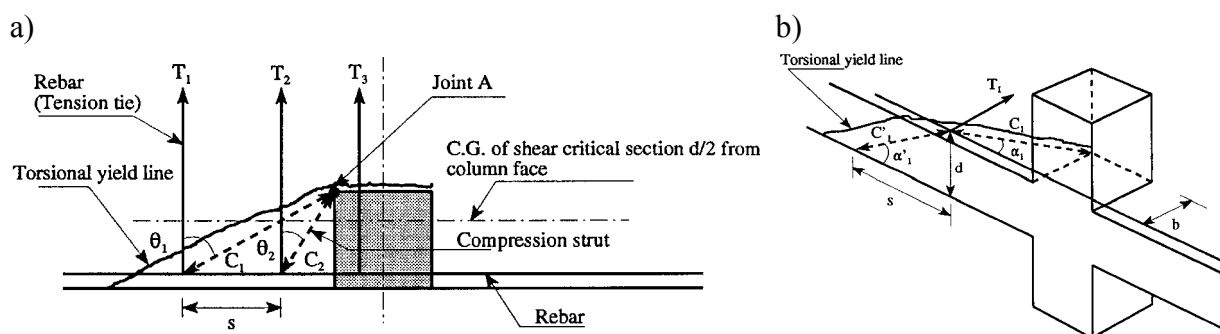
Fachwerkmodell nach Sherif (1996): a) Grundriss, b) Ansicht
